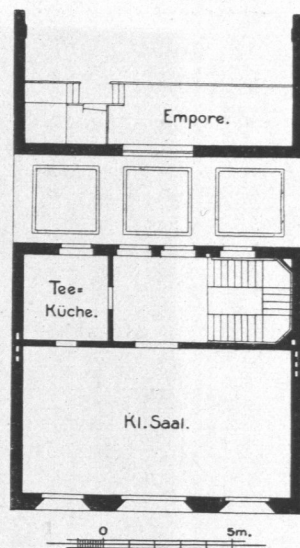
Volksheim Sachsenstraße, 1. Obergeschoß, Grundriß.
